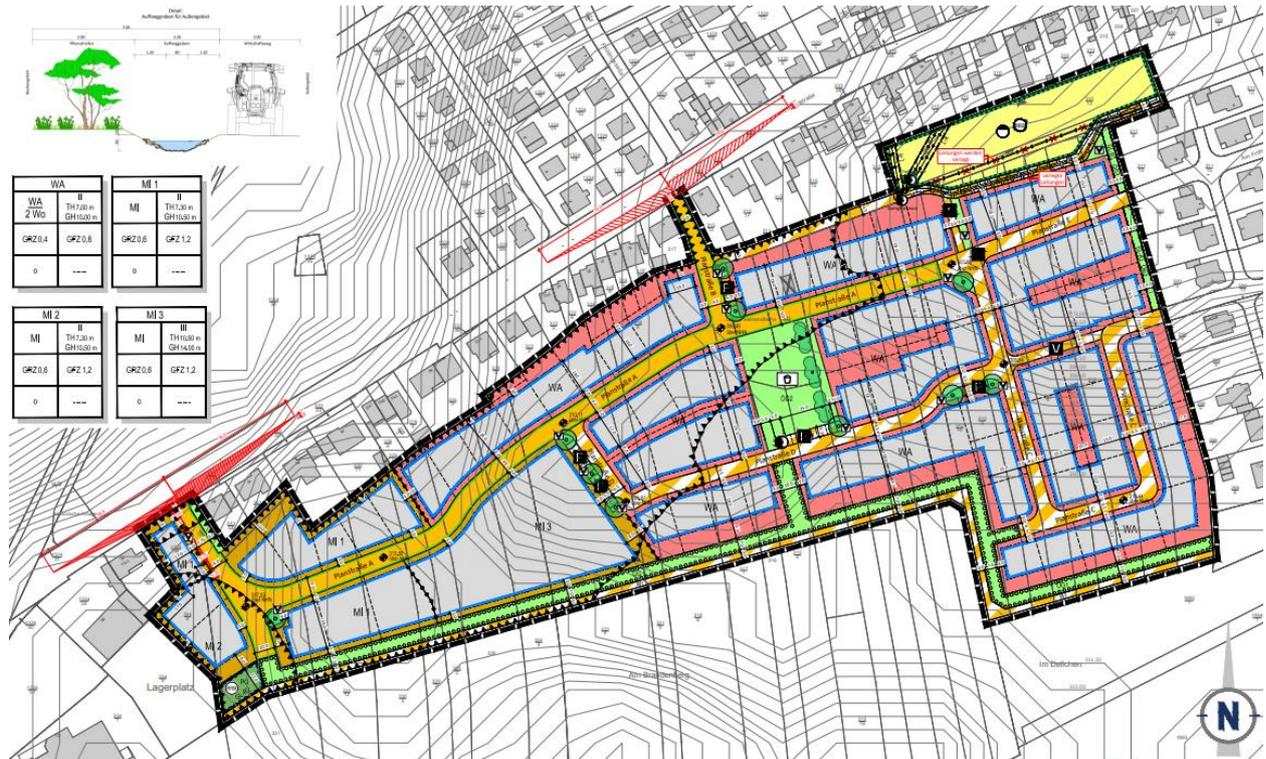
Entwurf des Bebauungsplans „Erweiterung Im Dellchen“, Teilplan A (Stand: April 2024)
